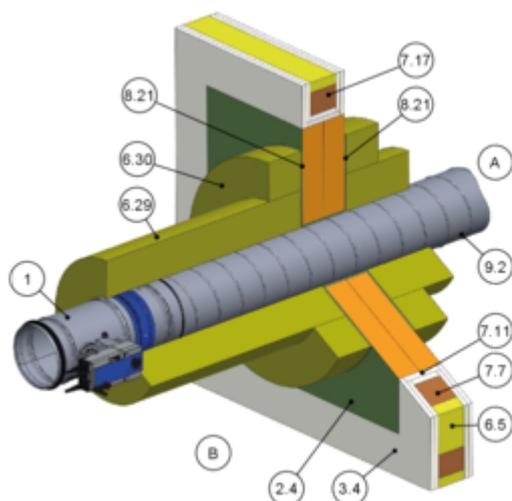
Montagem distante de paredes com vigas de madeira com lã mineral e enchimento de juntas
